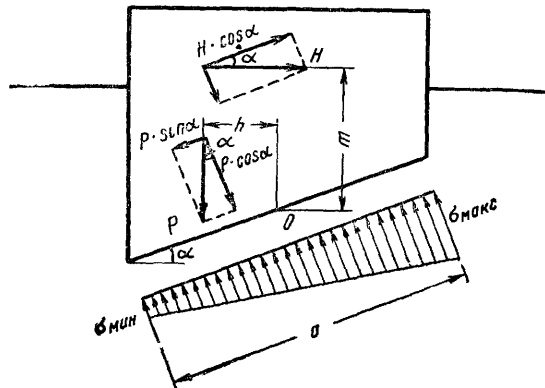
Схема к определению напряжений под наклонной подошвой фундамента
